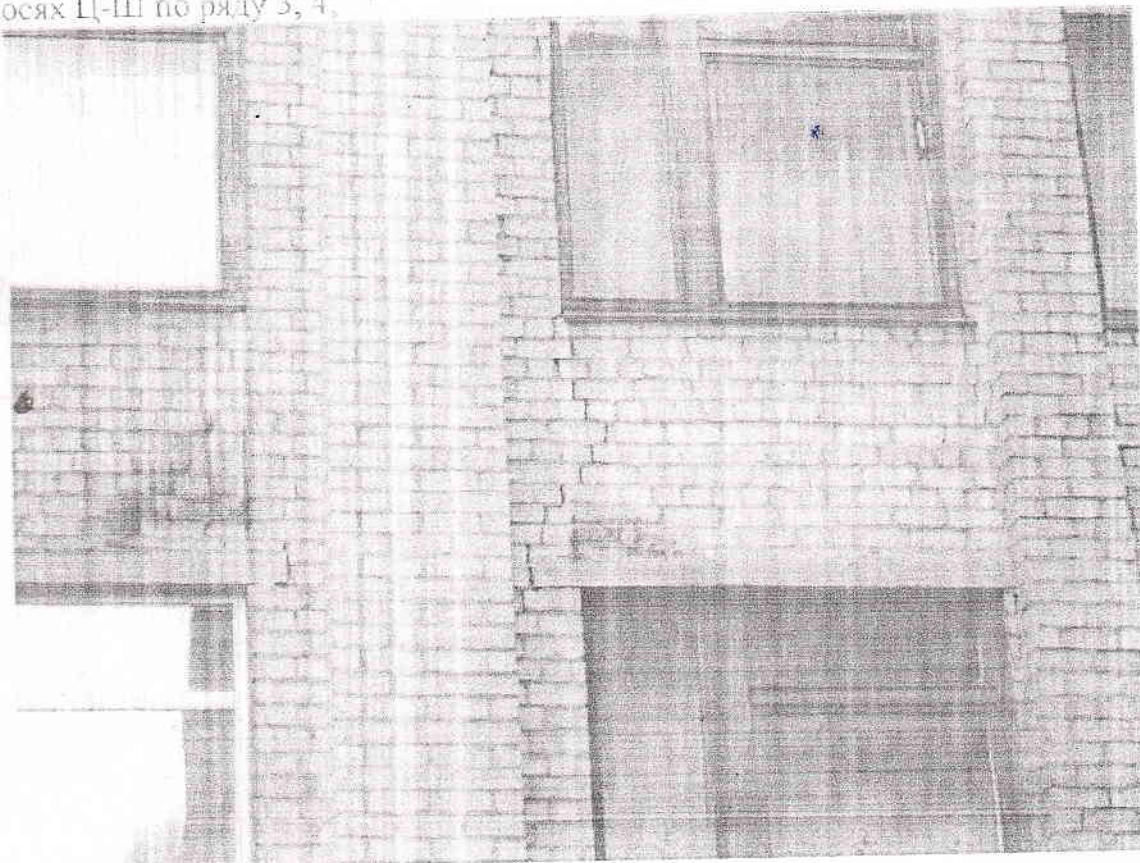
Д1 Вертикальные трещины в наружных и внутренних кирпичных стенах, на всю высоту здания, шириной раскрытия от 5 до 50мм. В осях Н – Ц, по ряду 1, 3, 4, и в осях Ц-Ш по ряду 3, 4;
